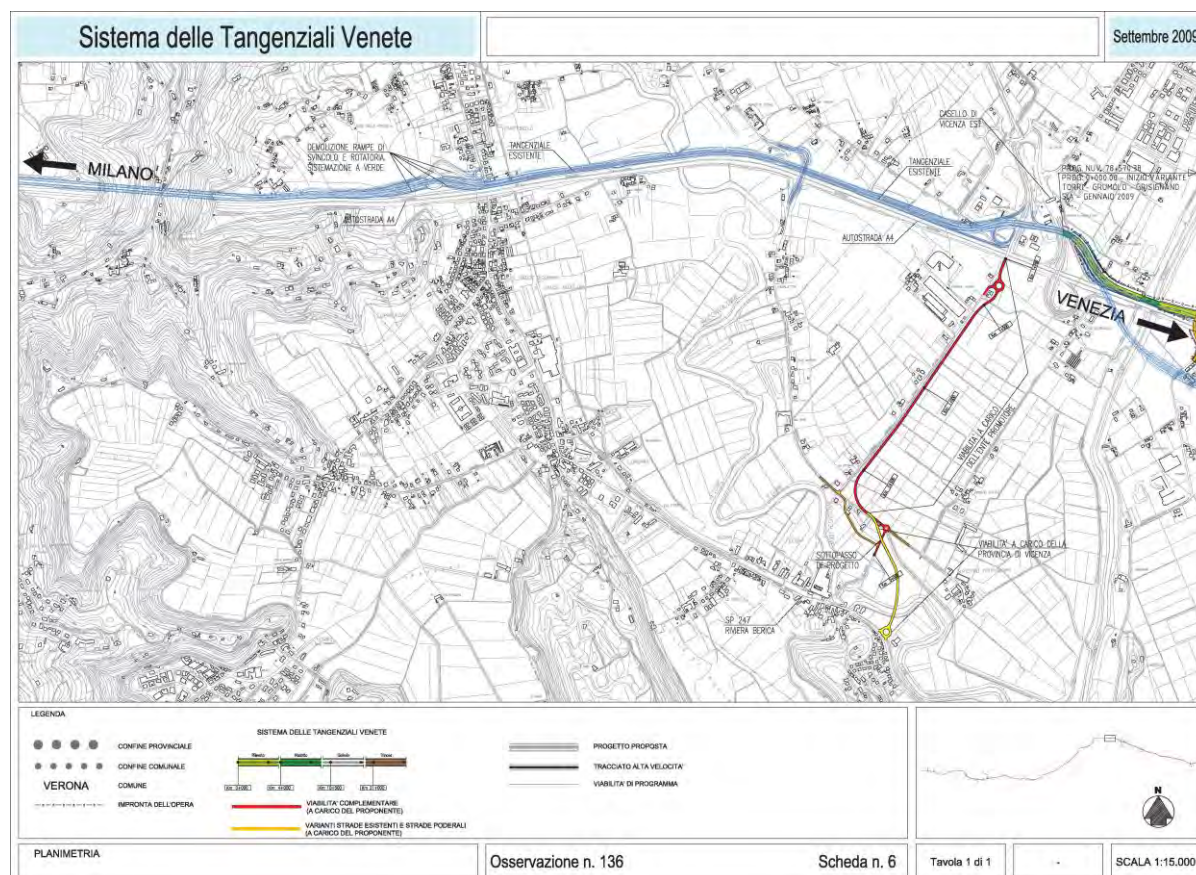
Planimetria osservazioni sistema delle Tangenziali Venete
